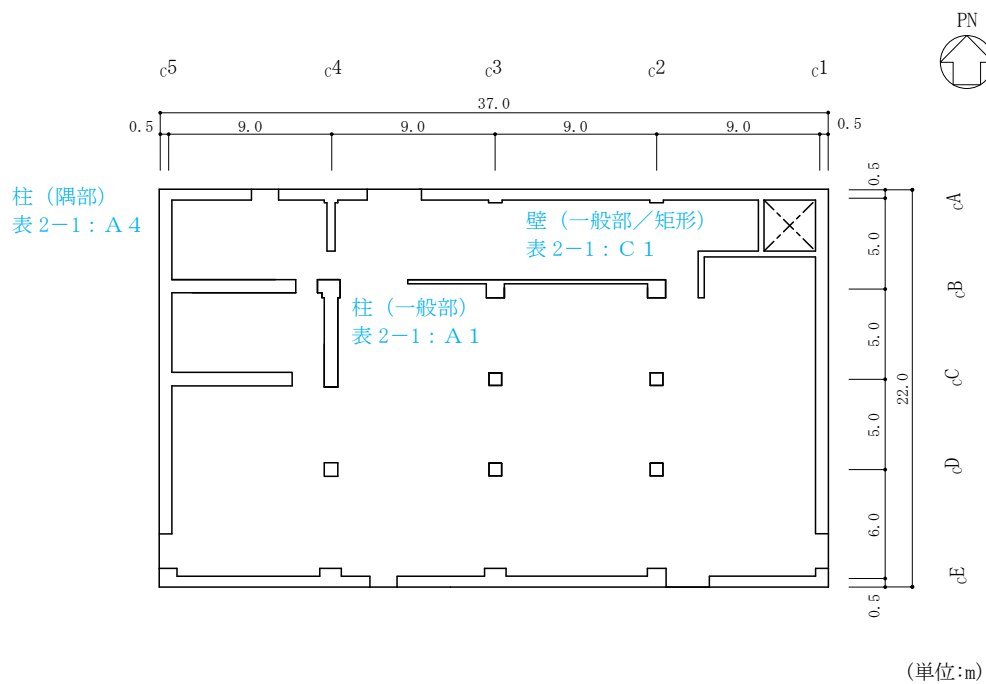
(2) 制御室建物の概略平面図 (EL 8.8m)
